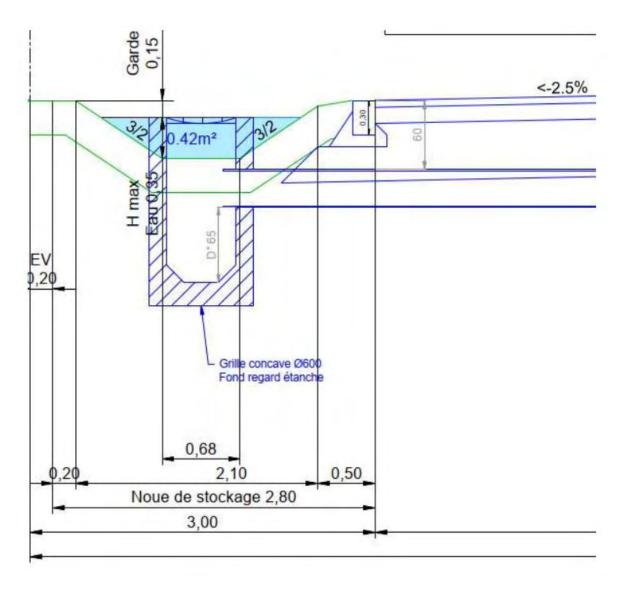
Schéma en coupe d'une noue en bordure de voierie
